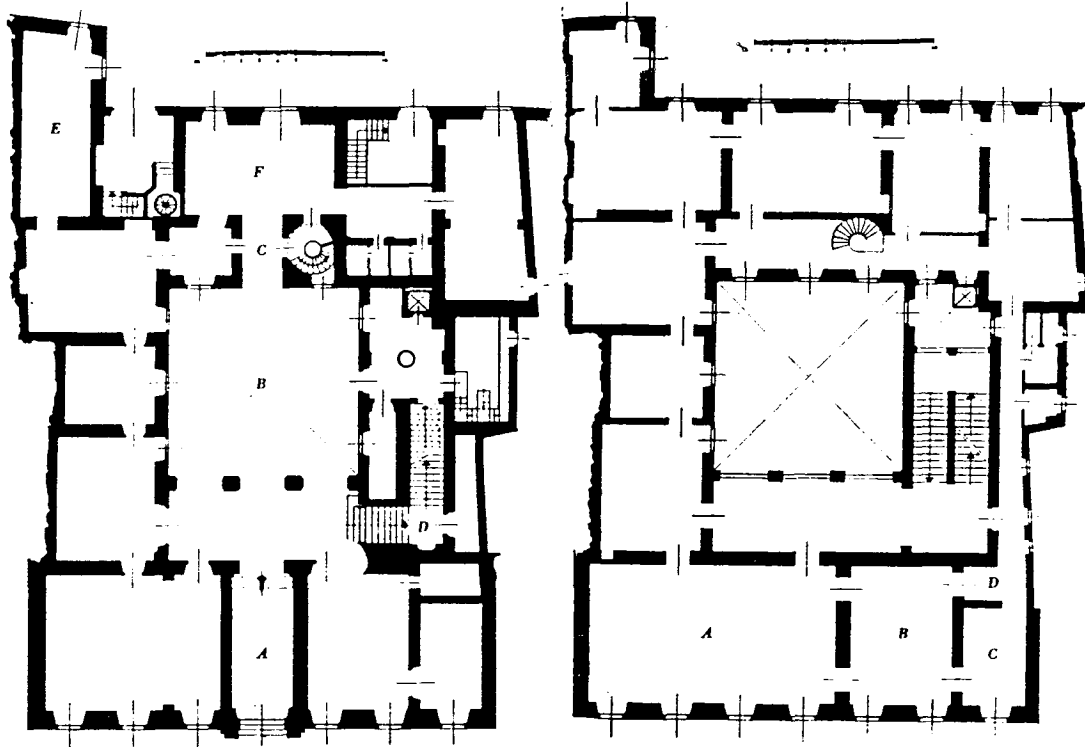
PALAZZO BALDASSINI - Pianta del pianterreno
